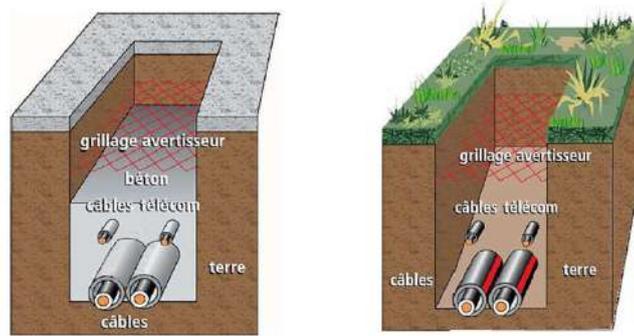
Coupes schématiques de fourreaux – PVC\* avec béton (gauche) et PEHD\* pleine terre (droite) (source : RTE, 2022)
